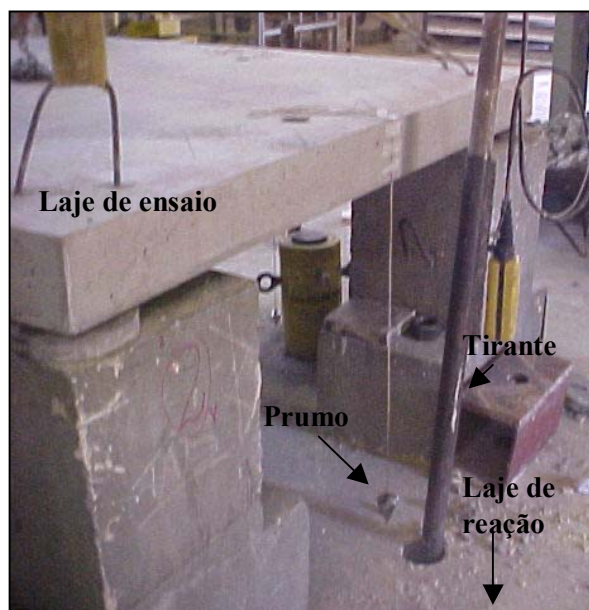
Sistema de ensaio e fotografia da laje – vista lateral - (mm)
